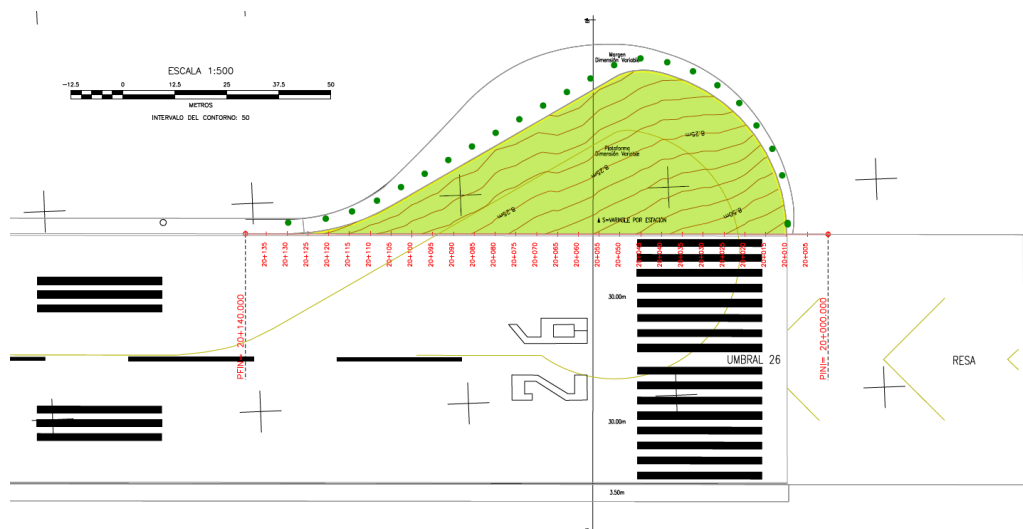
Planta General Reestructuración de Plataforma de Viraje 26⁹.
